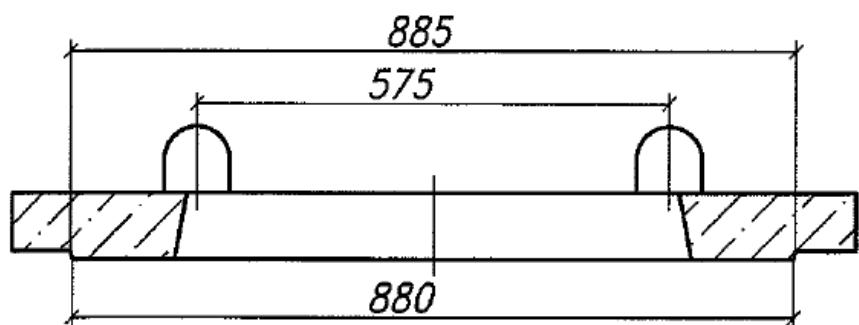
Размер выступа на нижней стороне плиты перекрытия
